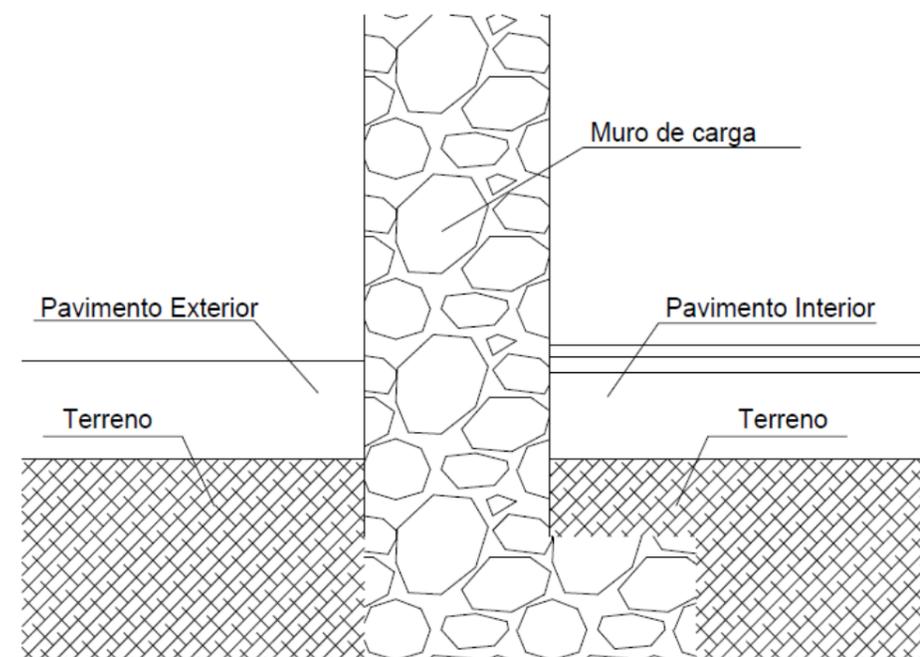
Detalle constructivo Cimentación, 2016. Fuente: Propio Autor
